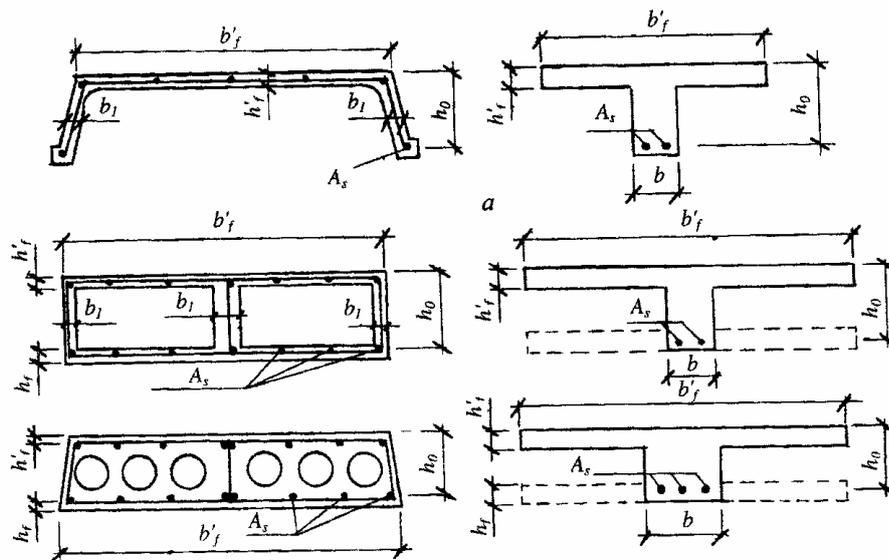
Способы приведения фактических сечений элементов к расчетному тавровому или двутавровому
